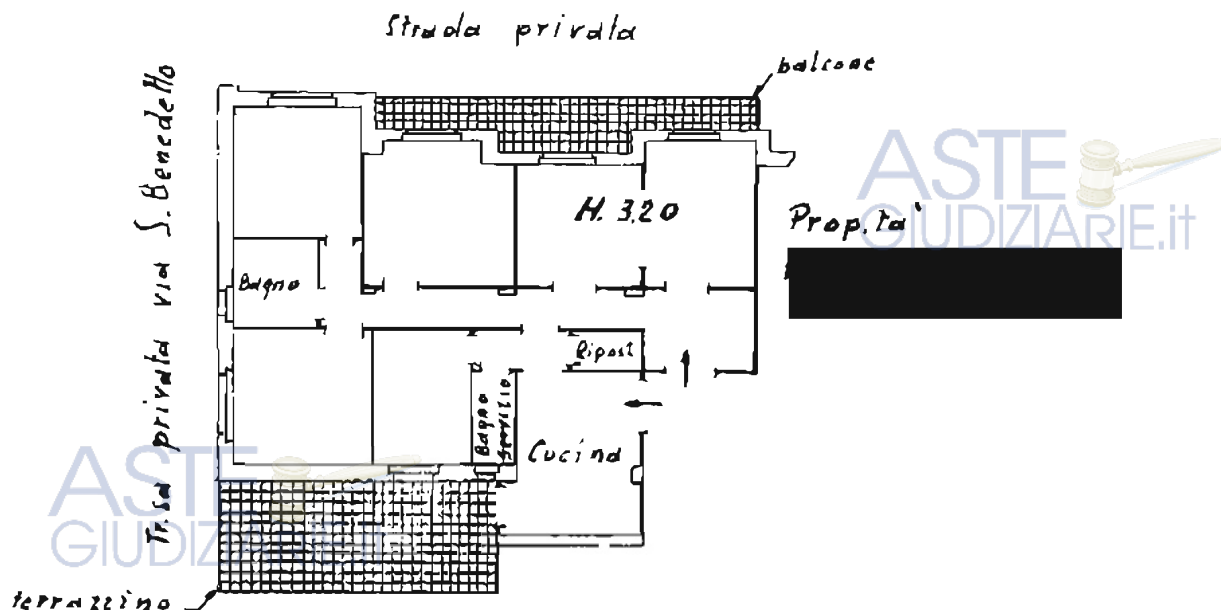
Planimetria catastale 1960 - Pianta piano primo
